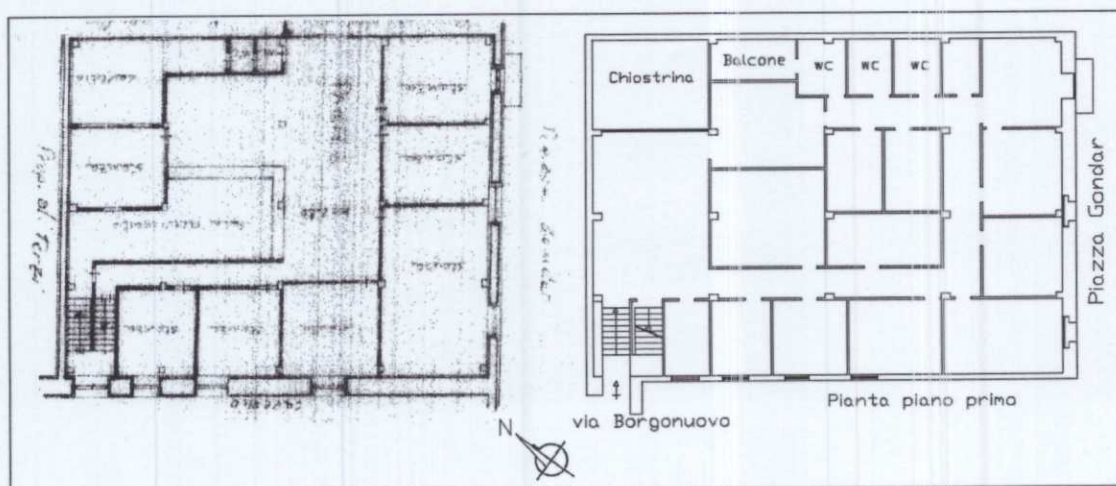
Confronto tra la planimetria Catastale (sinistra) e la planimetria dello stato reale dei luoghi (destra).
